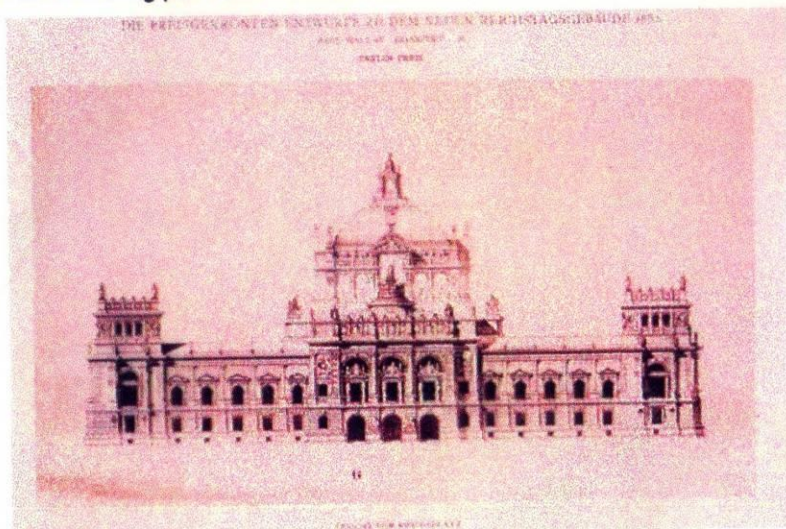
Façade principale du bâtiment Reichstag, de l'architecte Paul Wallot (Redecke, 7)
